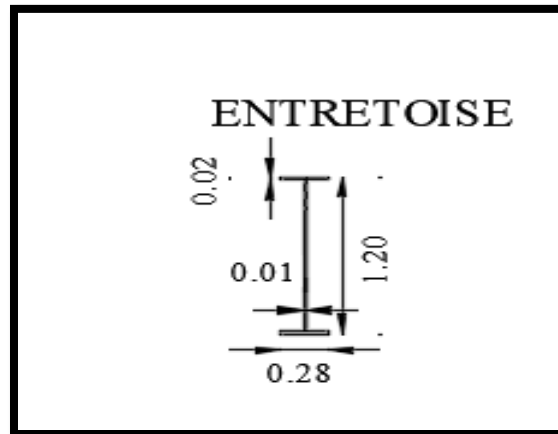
Coupe transversale de l'entretoise du pont de la variante 2.
